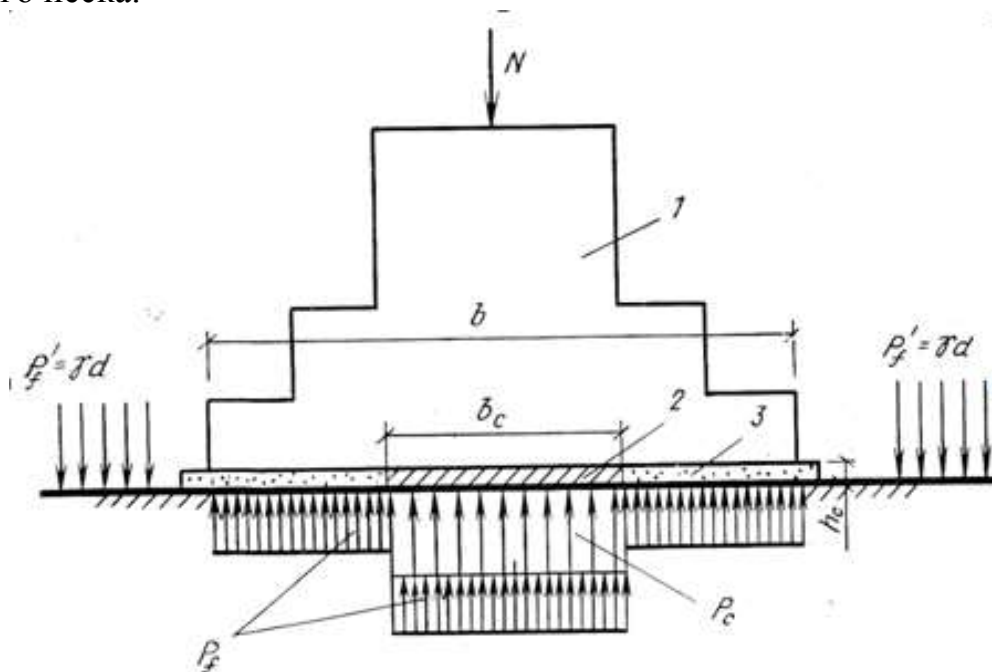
Фундамент с промежуточной подготовкой: 1 - фундамент;
